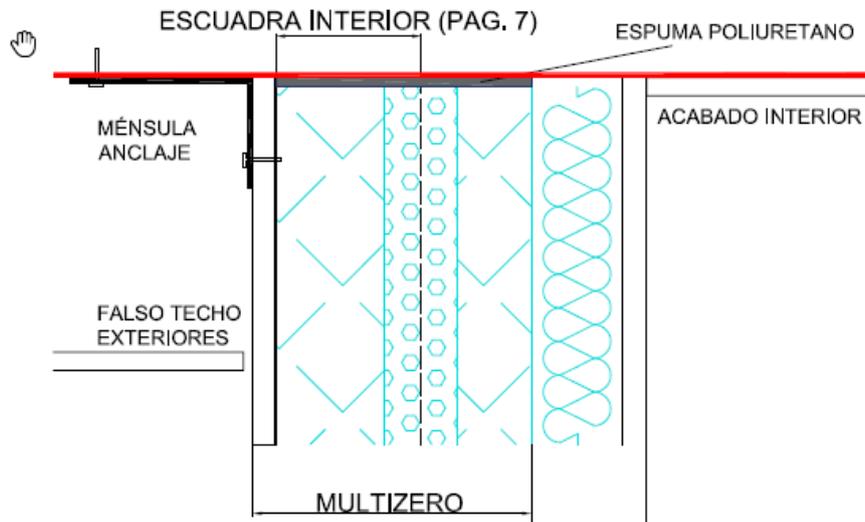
Sección horizontal - Encuentro entre cerramiento de fachada completo y pilar estructural
